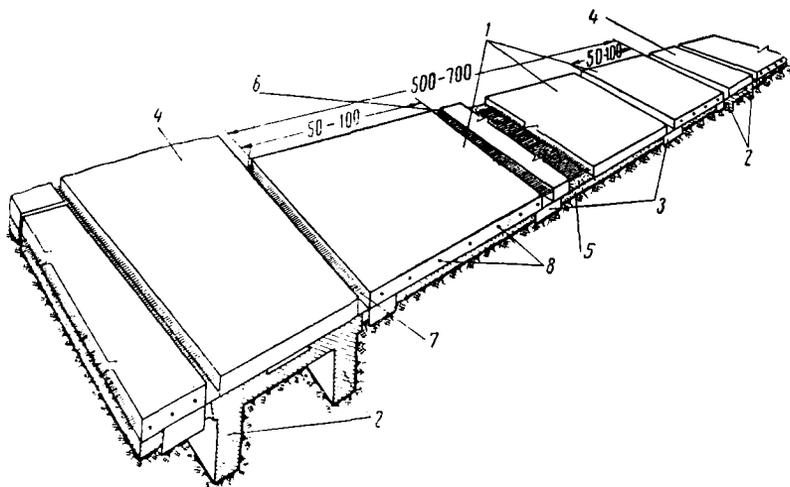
Предварительно-напряженное (струнобетонное) покрытие:
